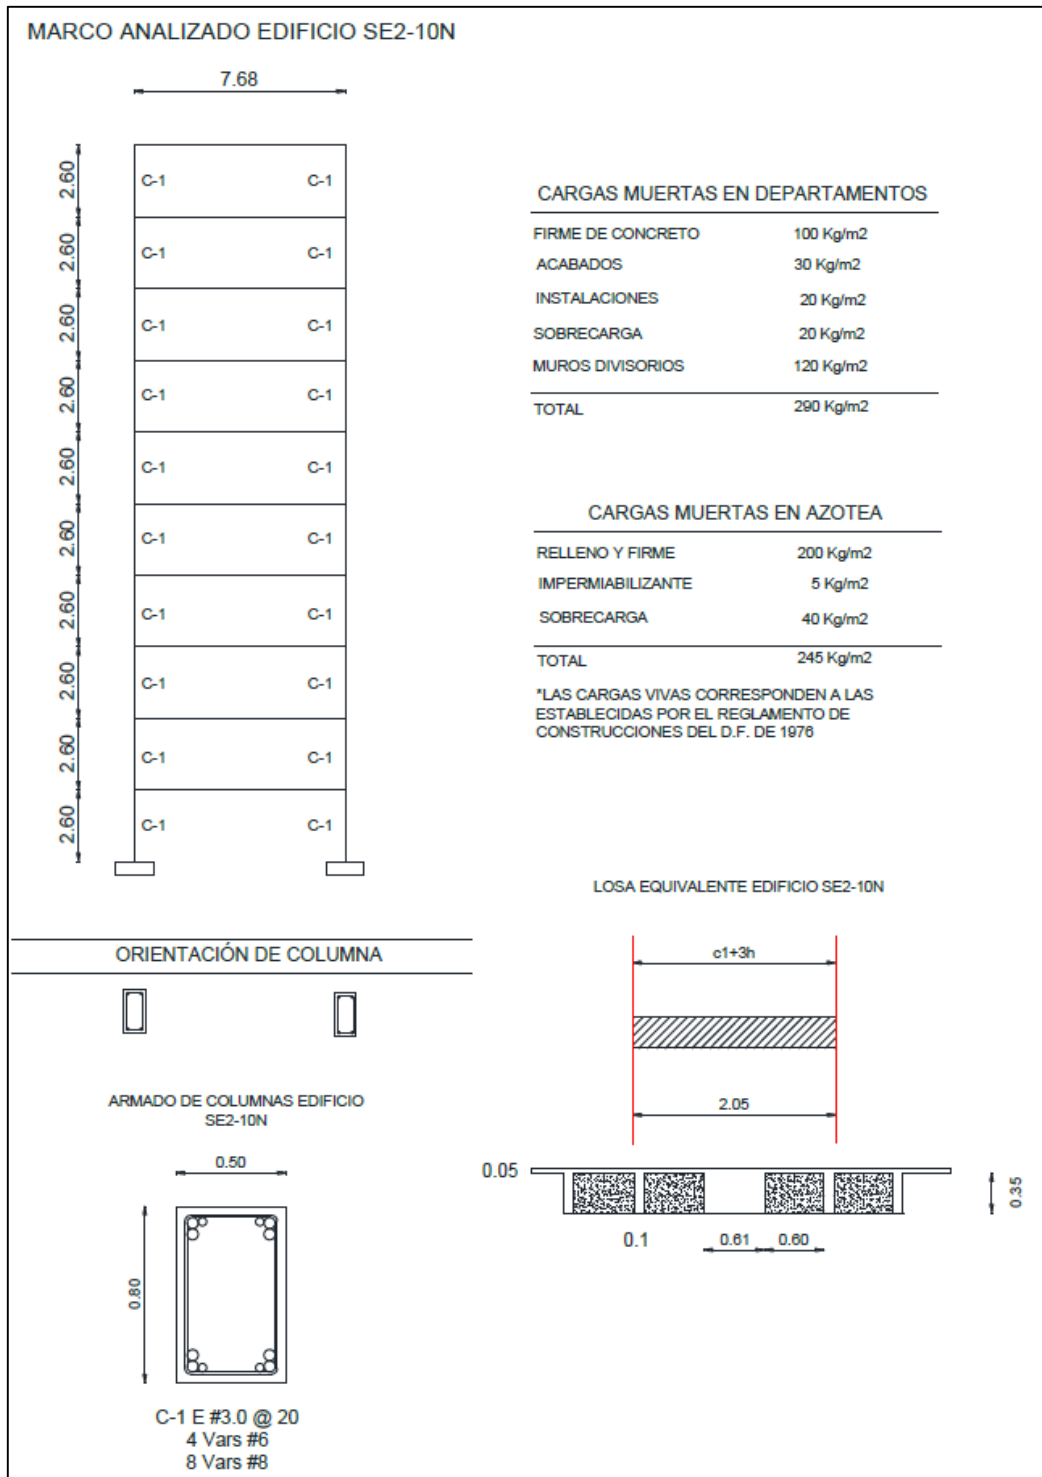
Detalles estructurales y cargas del edificio SE2-10N usadas en el análisis no-lineal.
